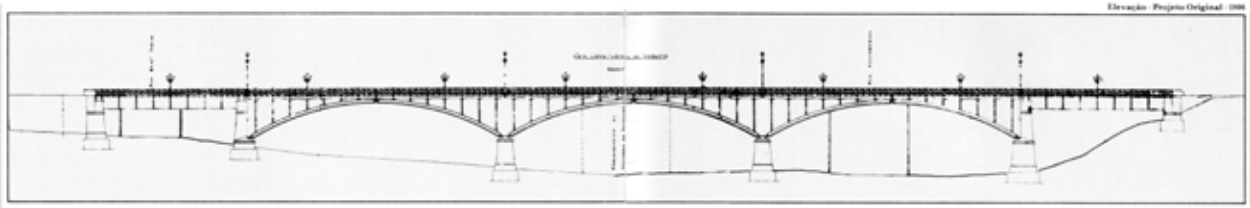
Elevação do projeto original do Viaduto Santa Ifigênia. Fonte: EMURB, 1979.
